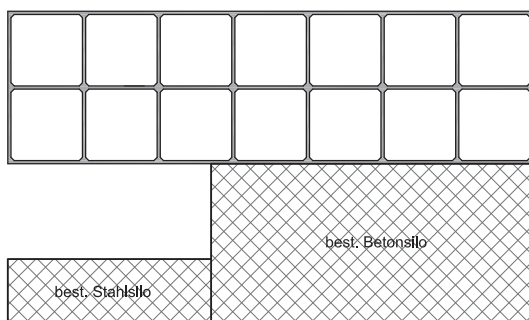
Grundriss Silo (Wälchli & Partner AG)
